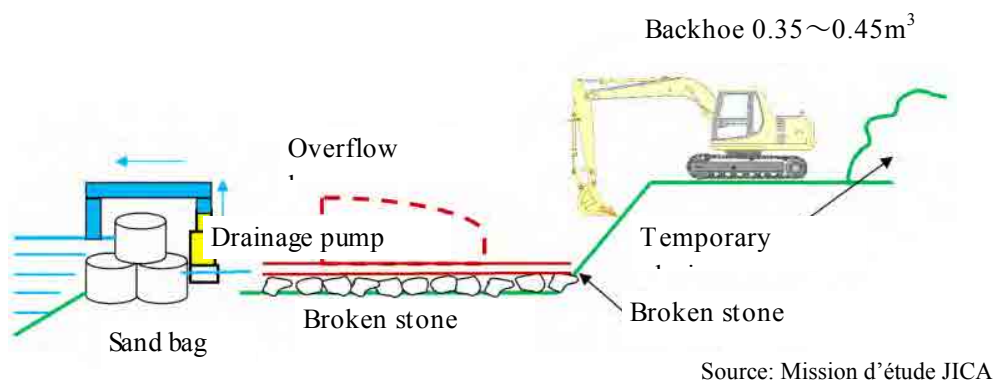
Procédé de l'excavation de fondations des ouvrages
